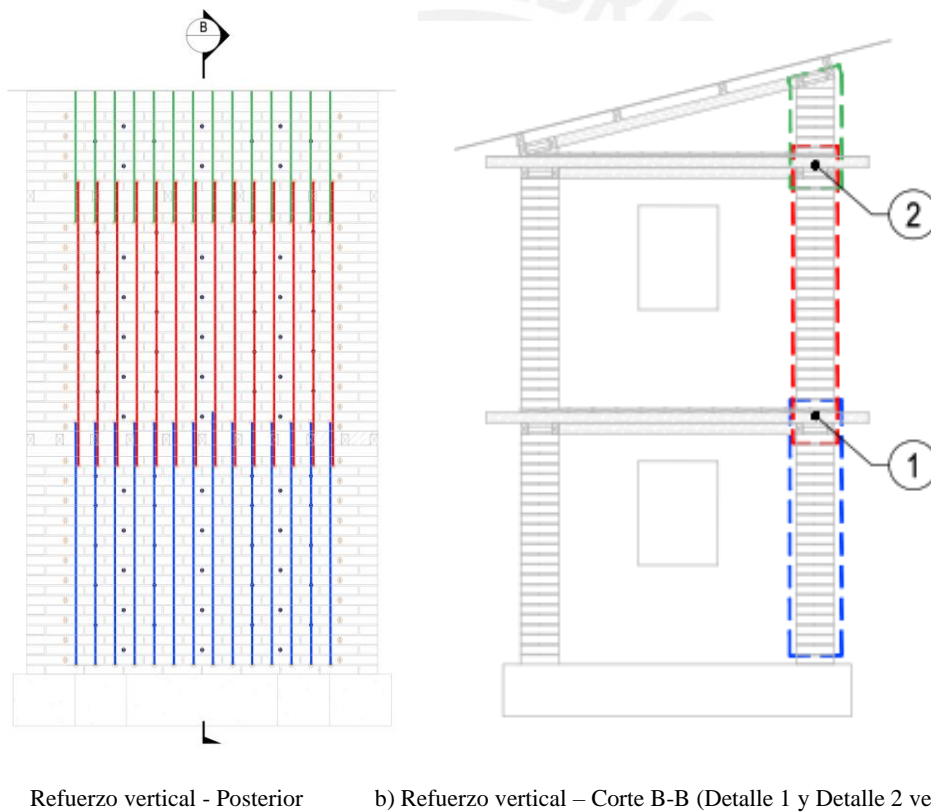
Refuerzo vertical en el muro anterior / Conexión de refuerzo entre el primer piso, segundo piso y techo
